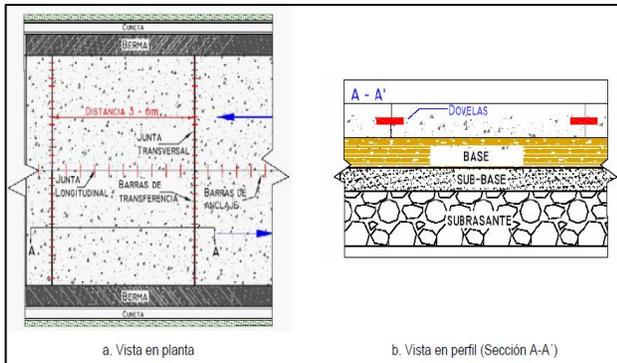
Pavimento Rígido con Juntas con Acero Mínimo (INVIAS, 2006).
